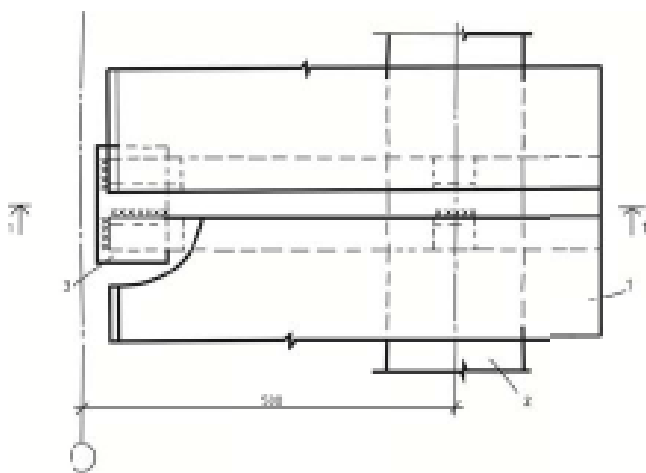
Крепление плит покрытия к стропильным конструкциям, расположенным у торца или антисейсмического шва здания.
